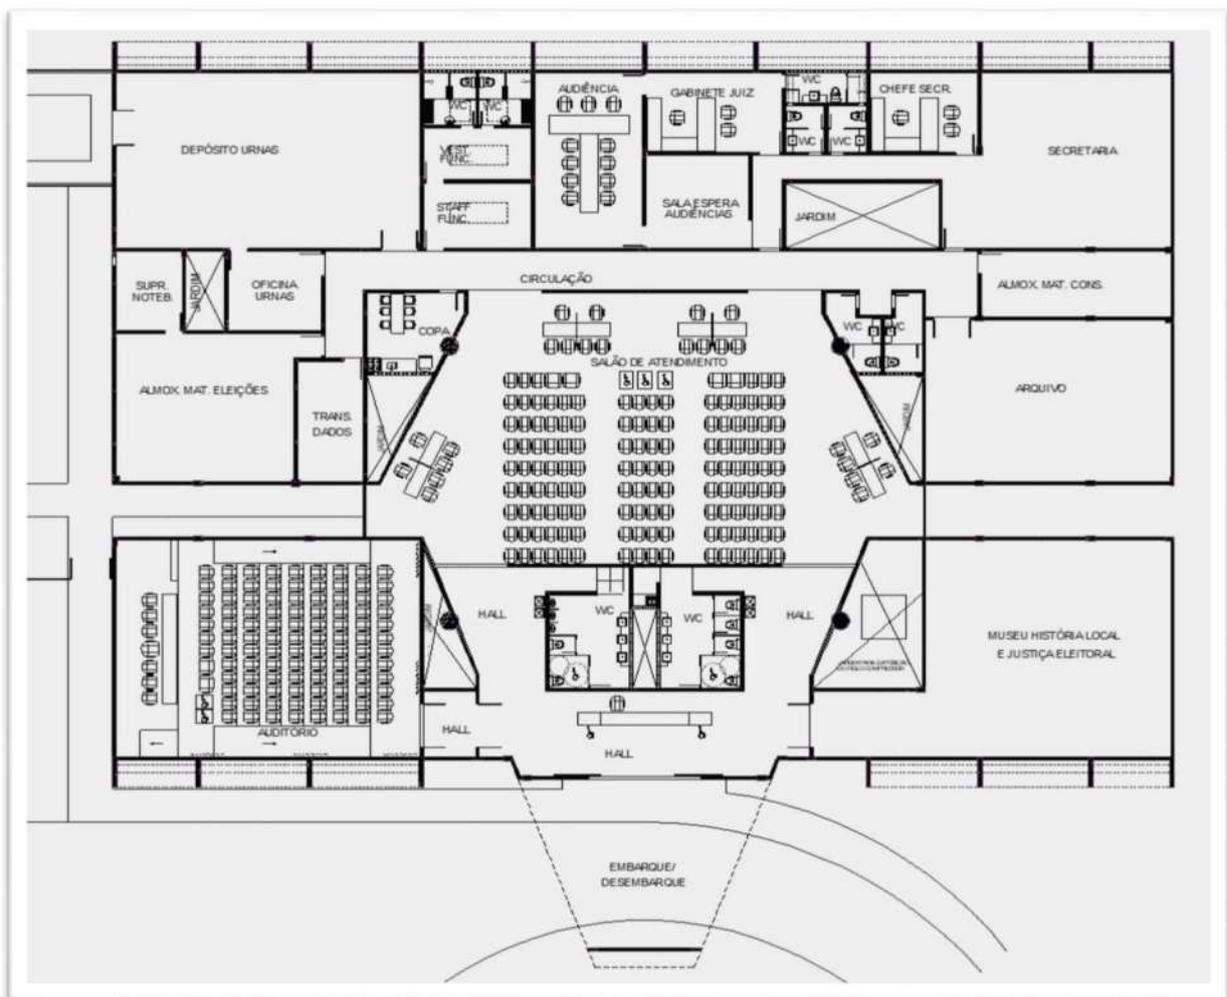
Planta baixa 4ª Zona Eleitoral
